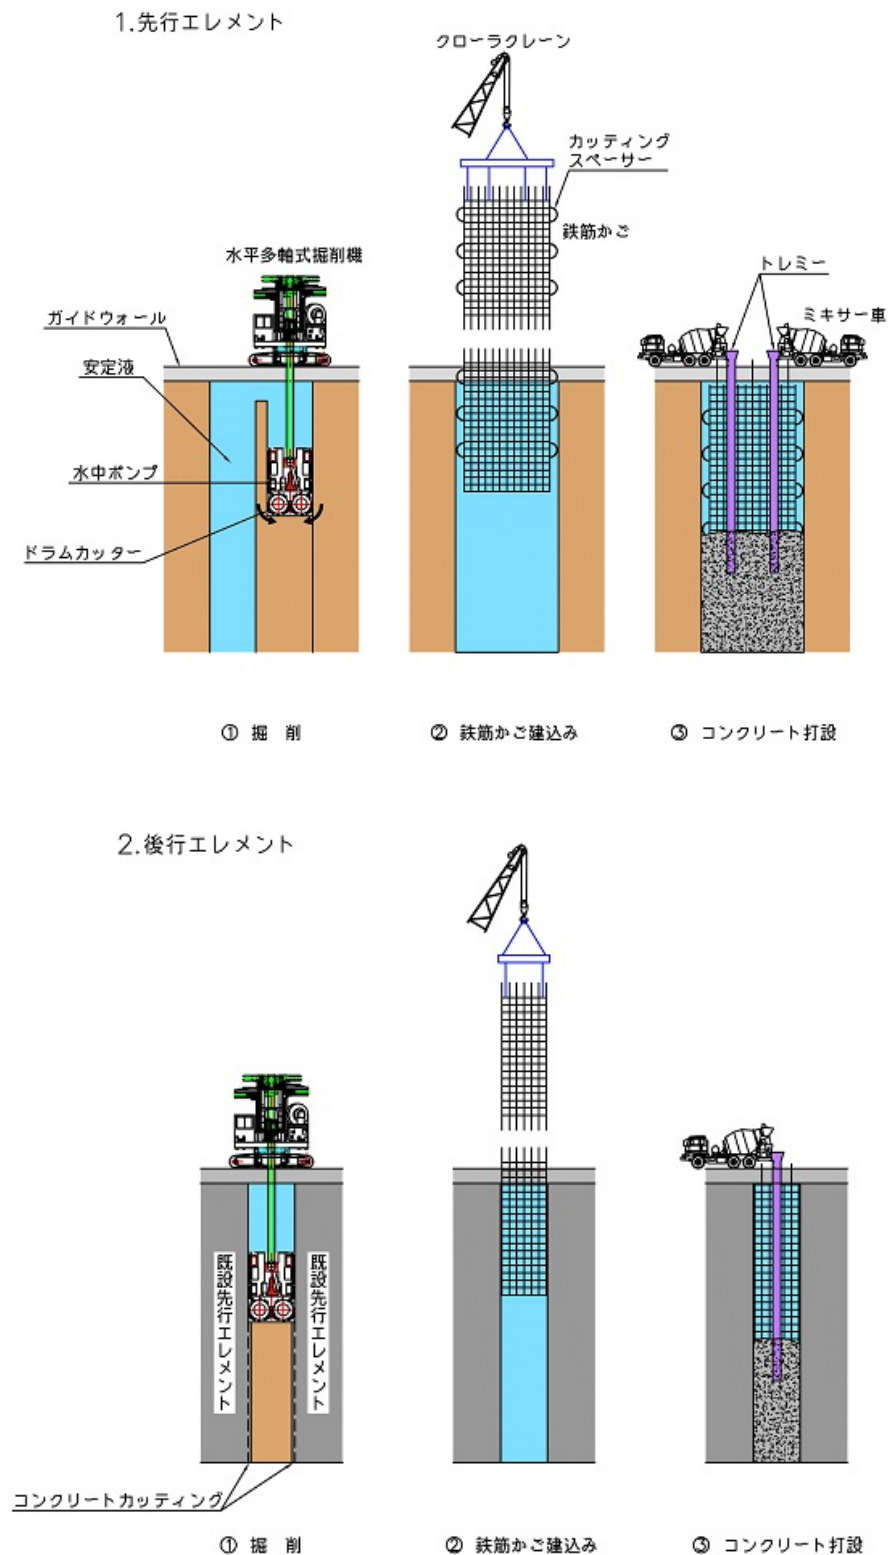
1. 1-3 地下連続壁の施工手順（コンクリートカッティング工法）³⁾
